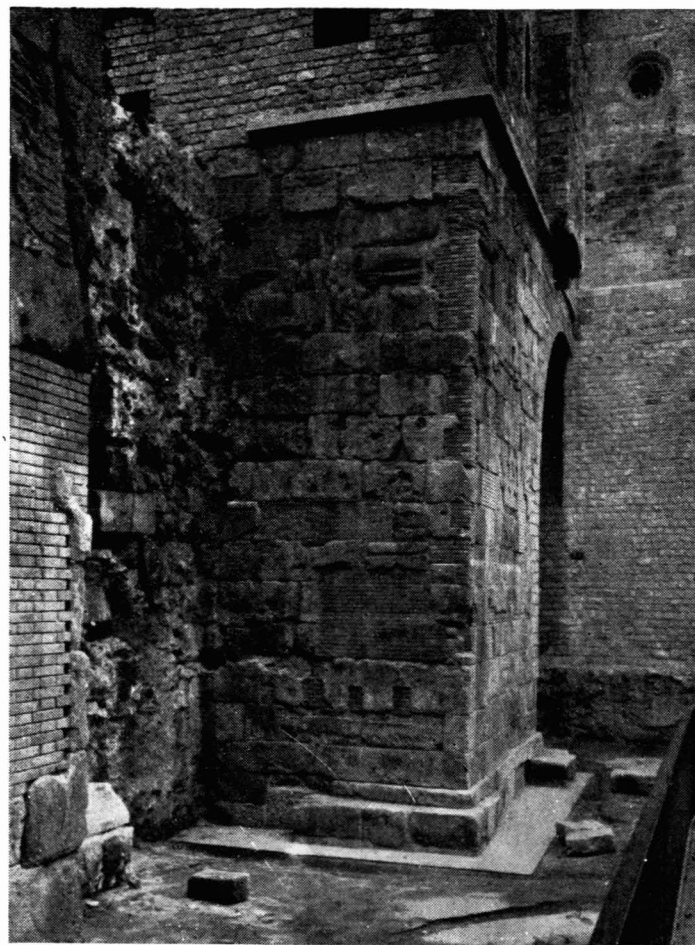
Torre de la muralla con la nueva cimentación de la base.
